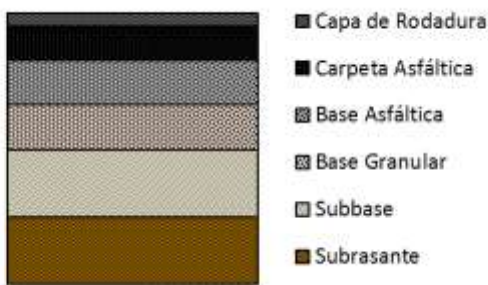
Capas del Pavimento Flexible. Elaboración propia.
